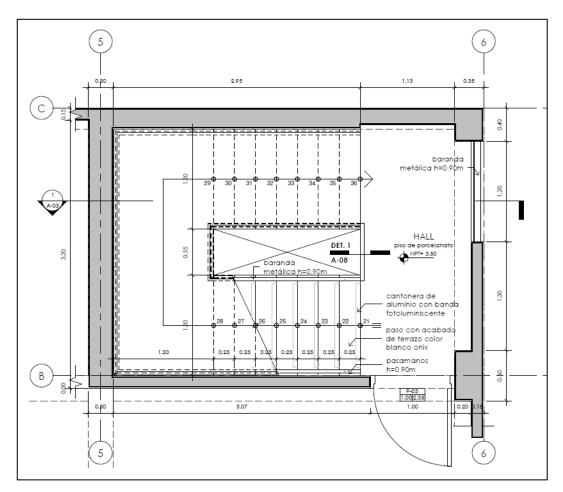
Sección de tramo típico de escalera de proyecto vivienda multifamiliar en Ate
